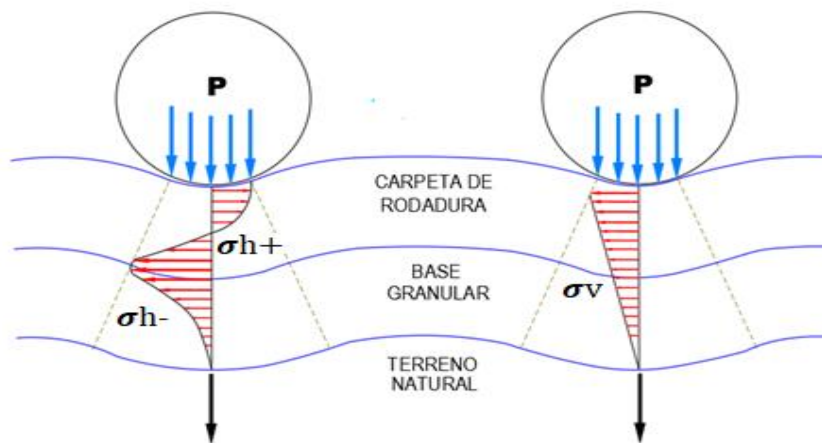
Distribución de esfuerzos en un pavimento flexible
